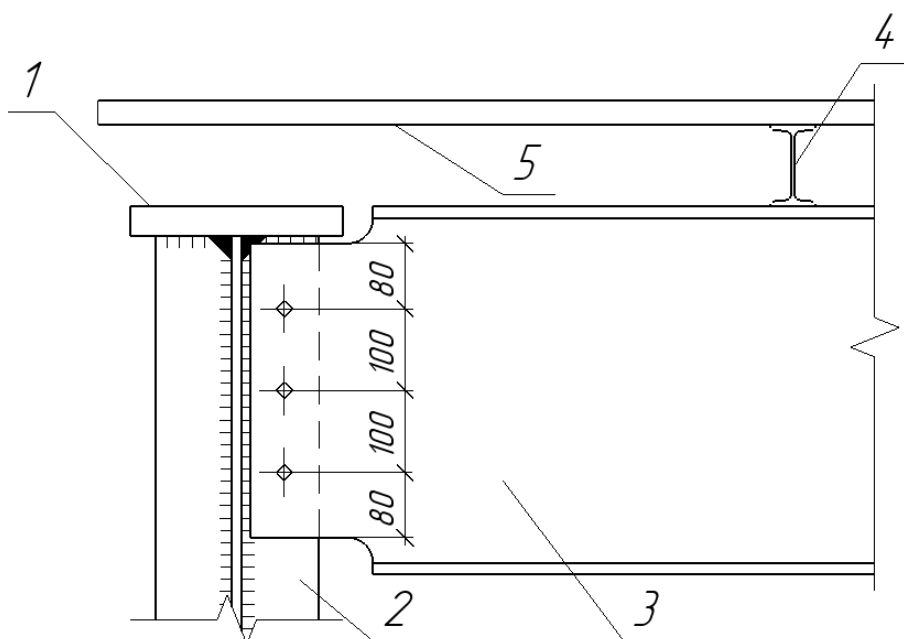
Узел сопряжения балок: 1 – главная балка; 2 – ребро жёсткости главной балки; 3 – вспомогательная балка; 4 – балка настила; 5 – стальной настил
